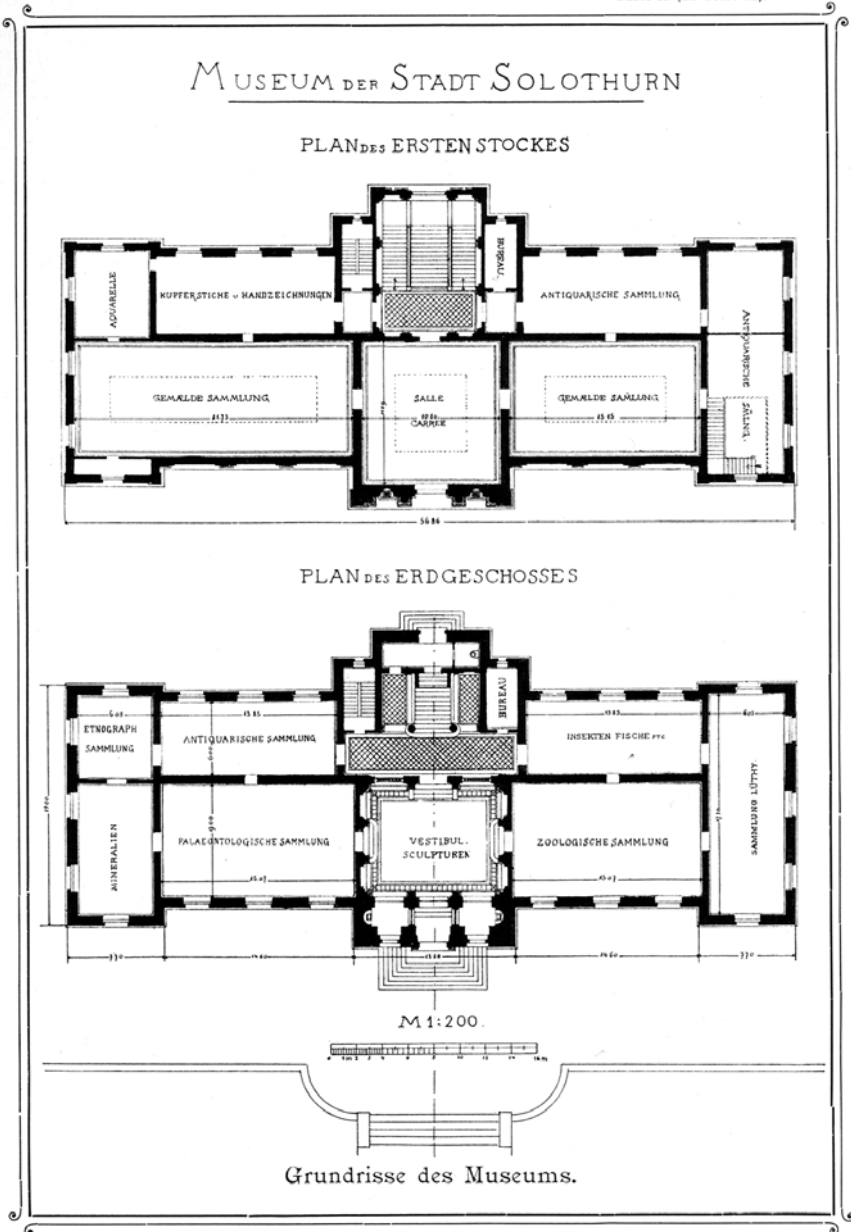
Grundrisse des 1902 eröffneten, mehrpartigen
